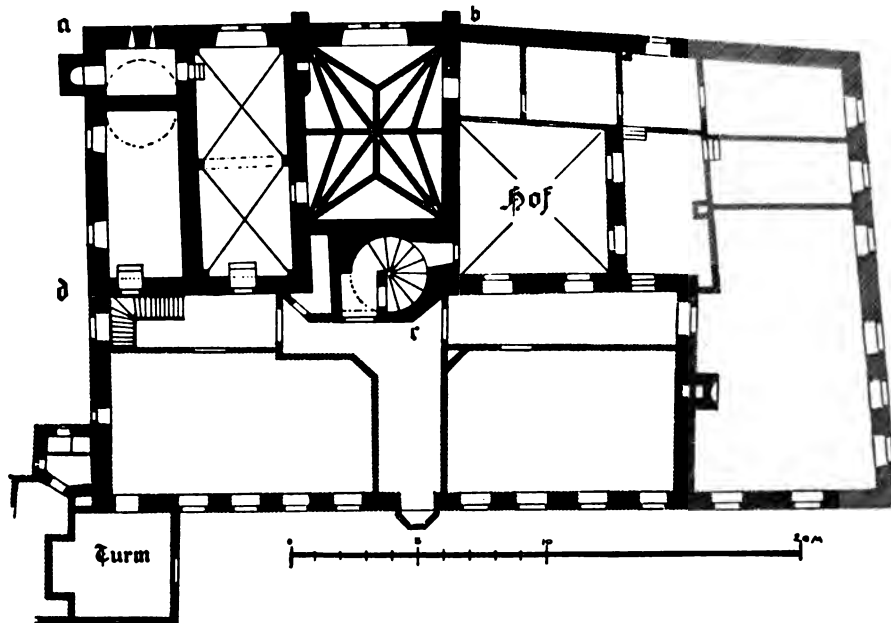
Radesheim. Brömserhof. Grundriss des westlichen Teiles.
